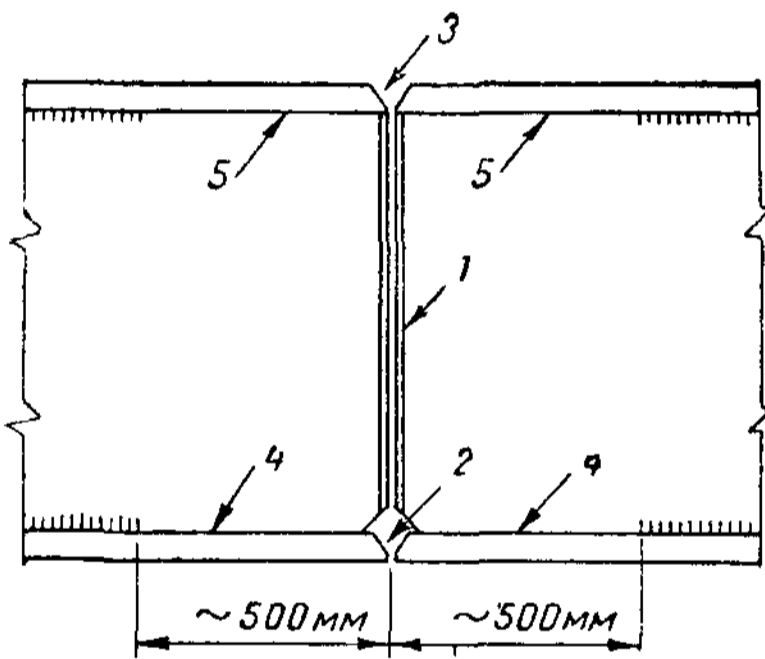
Монтажный стык сварной балки, выполняемой без кантовки балки наверху
